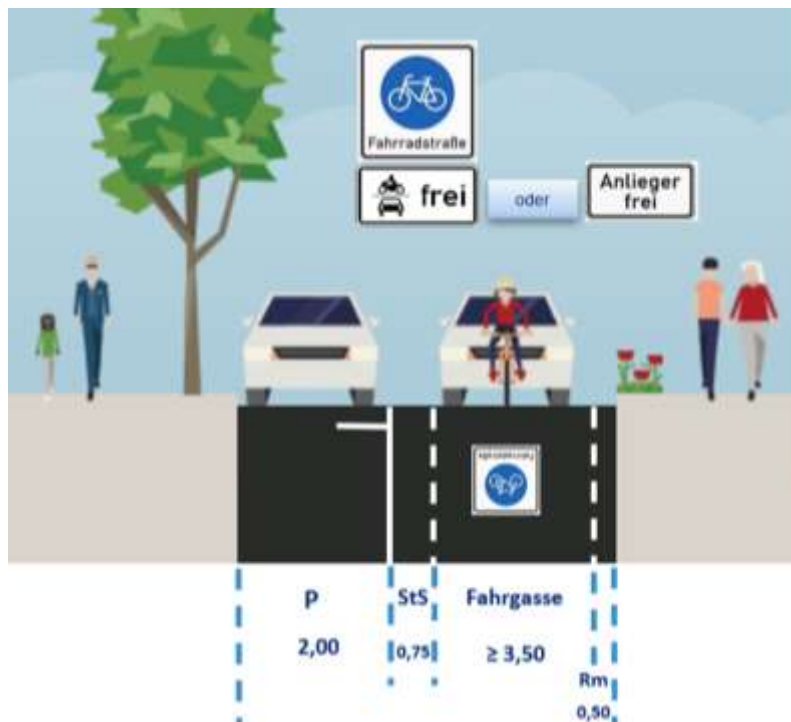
Markierungsstandard für Querschnitte in Einbahnstraßen
